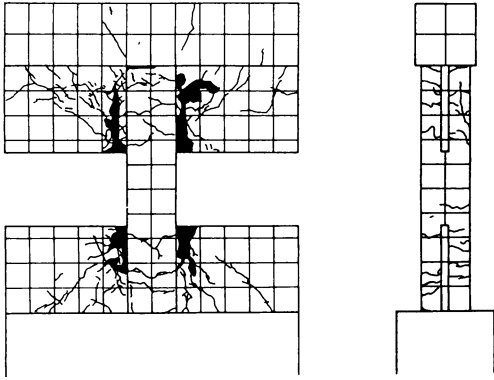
(c) 試験体 CSS03 の実験終了時のひび割れ図
